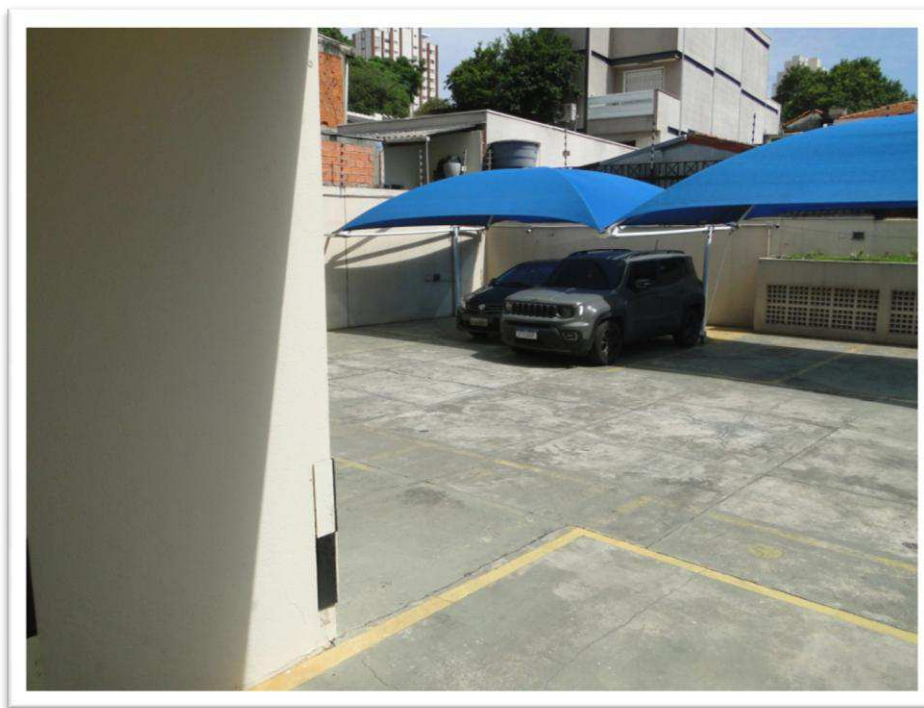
Vista parcial do estacionamento de veículos no pavimento térreo do prédio.
